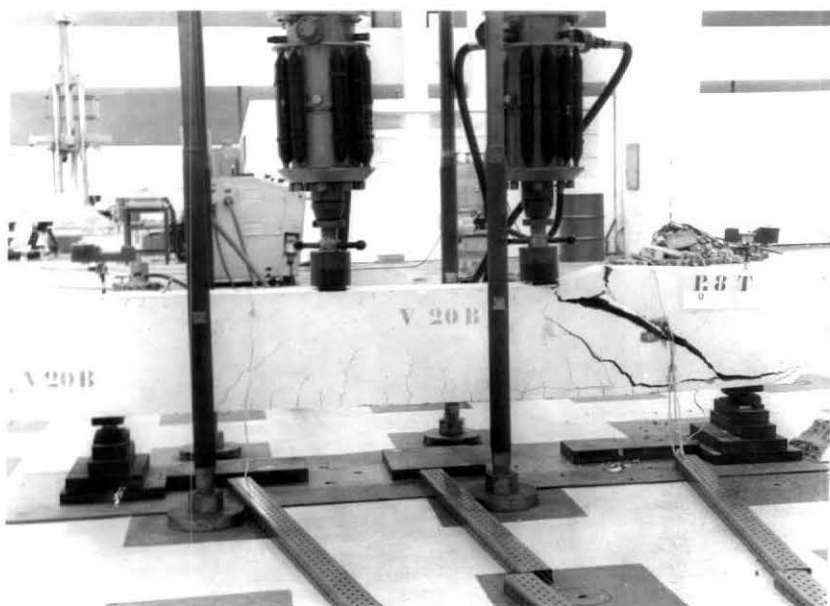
Ruptura da viga 20B ($a/d=2,0$) por tração na borda superior, causada por compressão excêntrica do bloco de concreto acima da fissura de cisalhamento.
